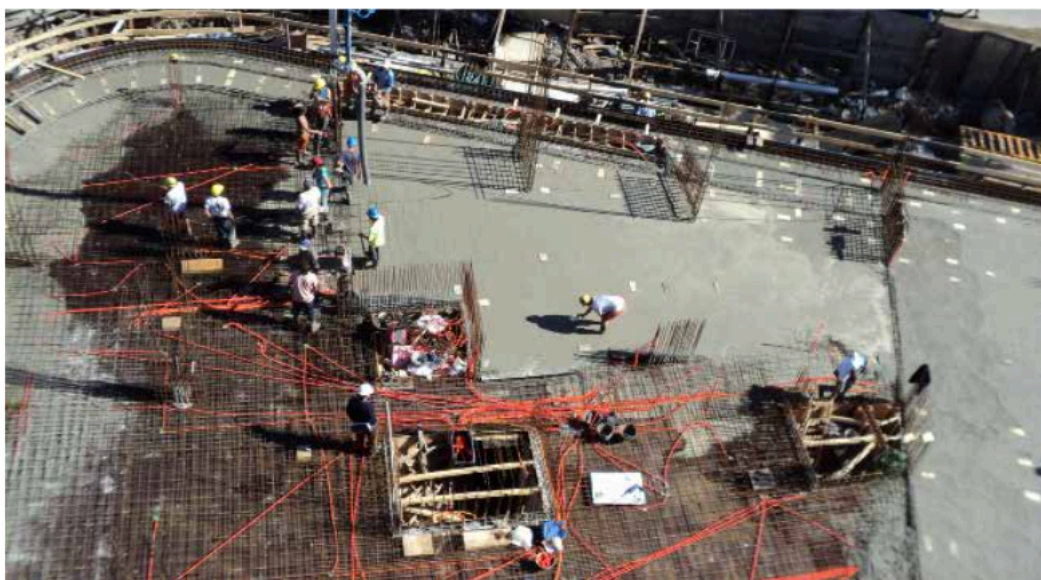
Vista aérea de la superficie de una planta durante un llenado
